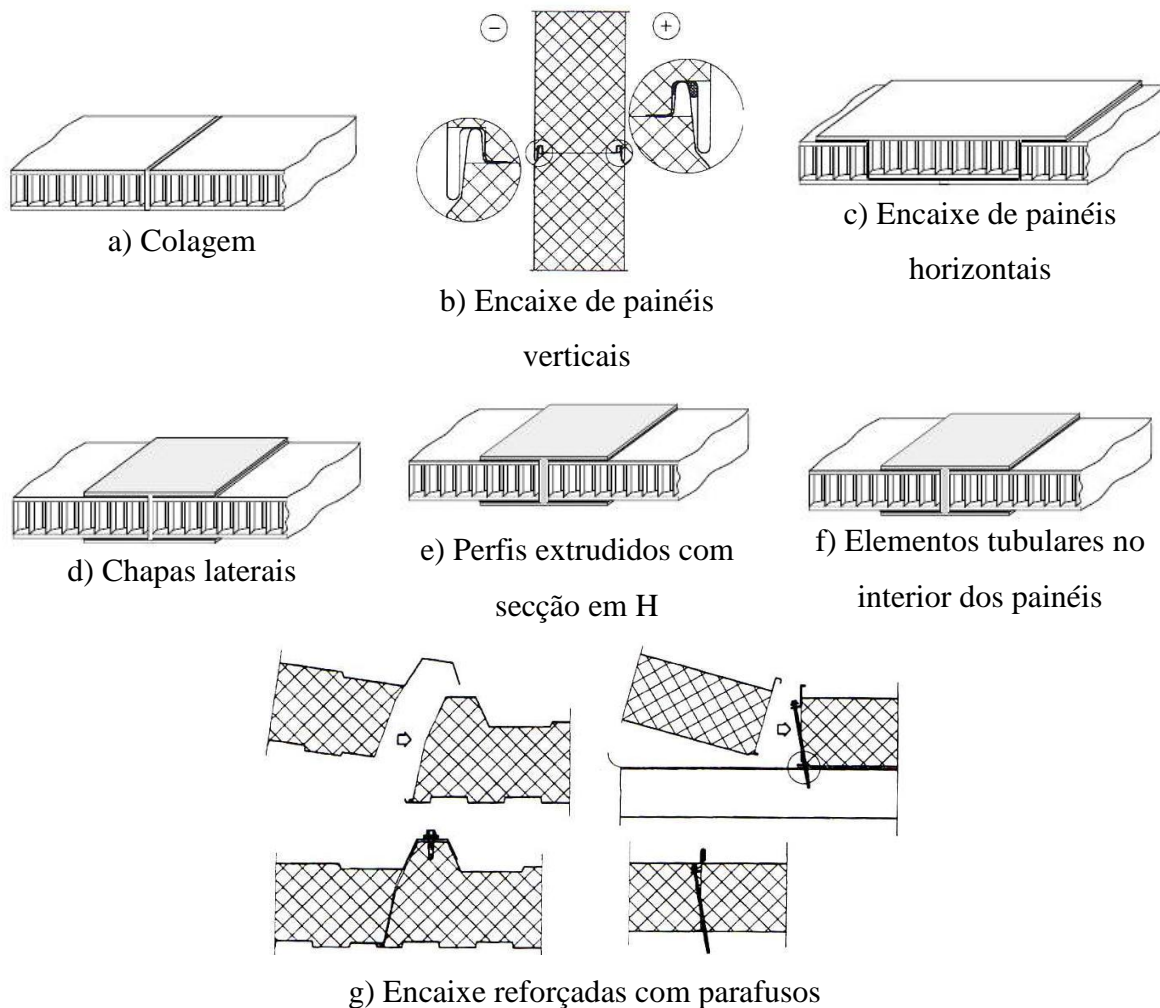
Ligações entre painéis sandwich (adaptado de: Almeida, 2009)
